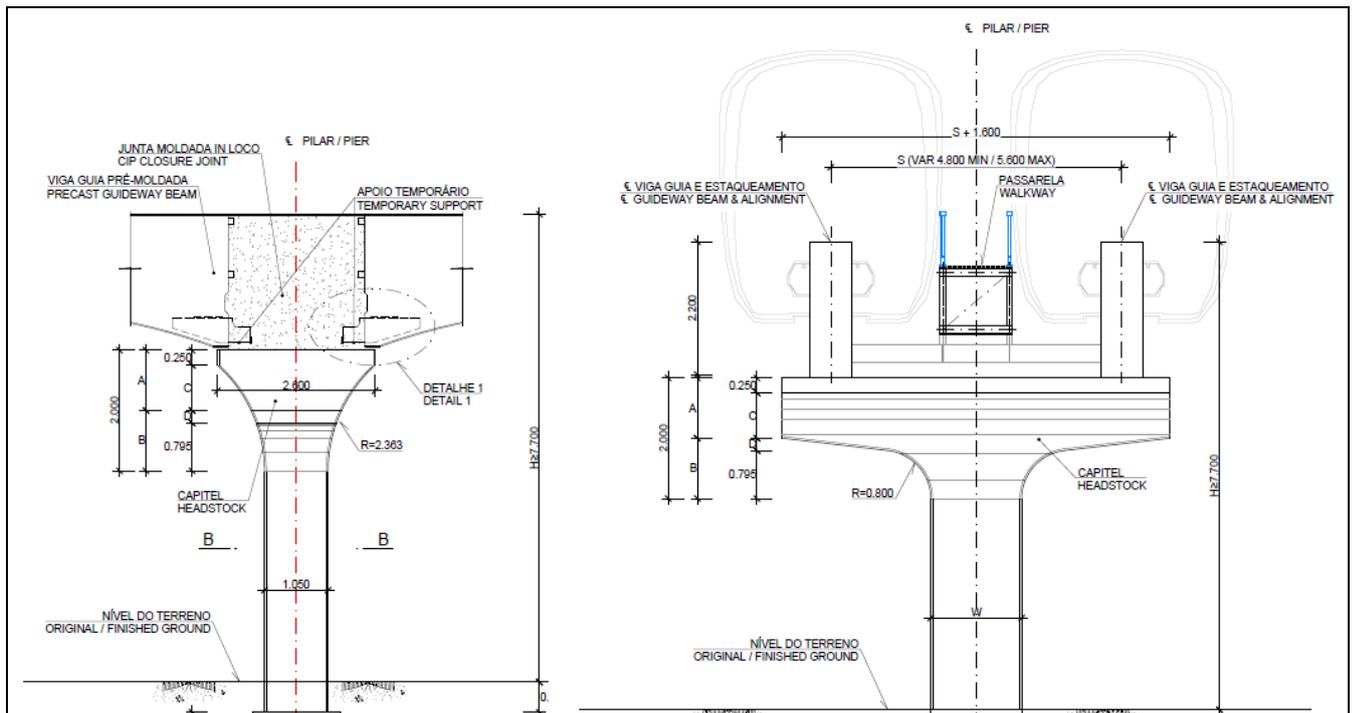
Forma Estrutura Via Elevada Tipo 1A (Planta DE-MG.00.EL_C.EC2-002).
